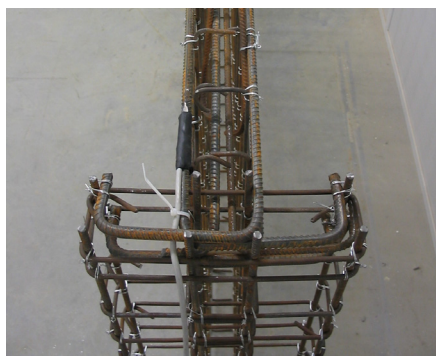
Pormenor das armaduras do tirante principal e do extensómetro EC2.
